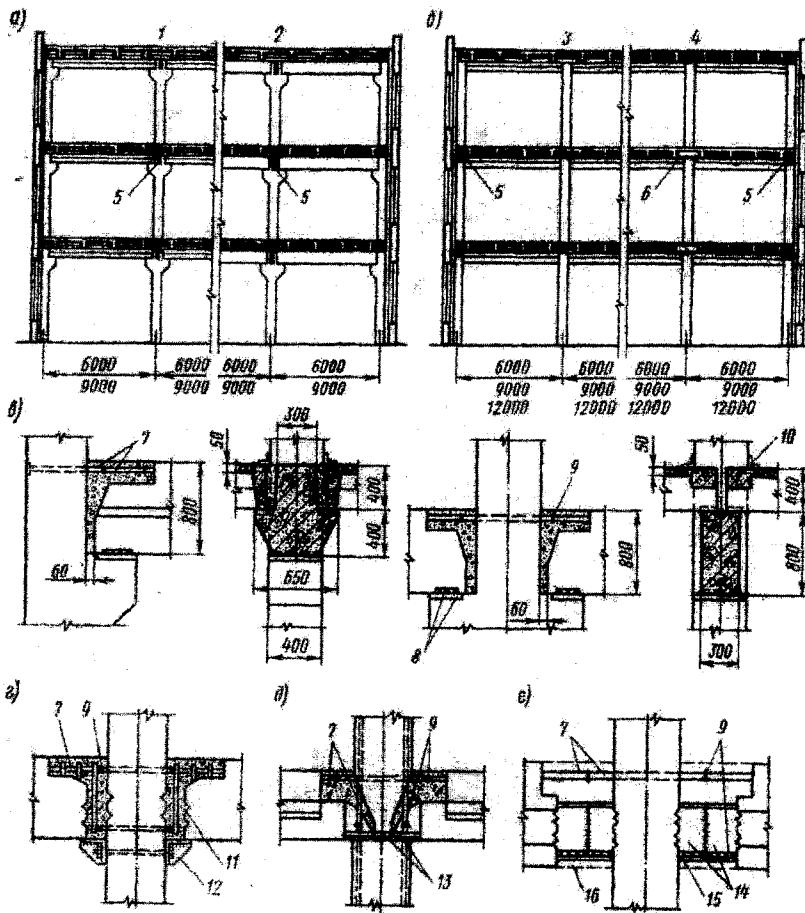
Багатоповерхові будівлі зі збірним балочним каркасом:
